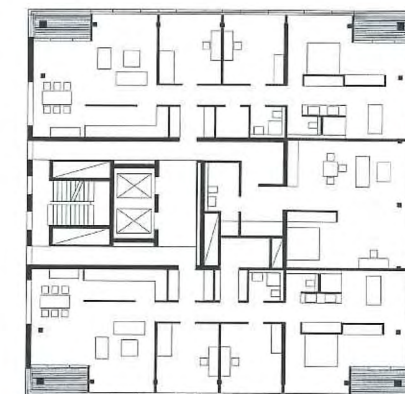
Grundriss Aufstockung: 15. und 16. OG, Dreispänner (Quelle: Stefan Forster Architekten)
